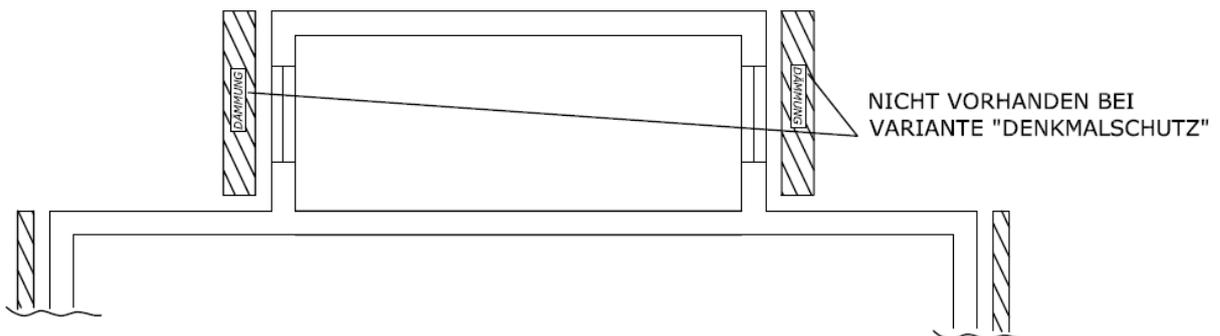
Vereinfachte Darstellung der zwei Hauptgruppen der untersuchten Sanierungsvarianten – „Staffelgeschoss saniert“ bzw. „Dachflächen Bestand“ [Schöberl & Pöll OEG]
